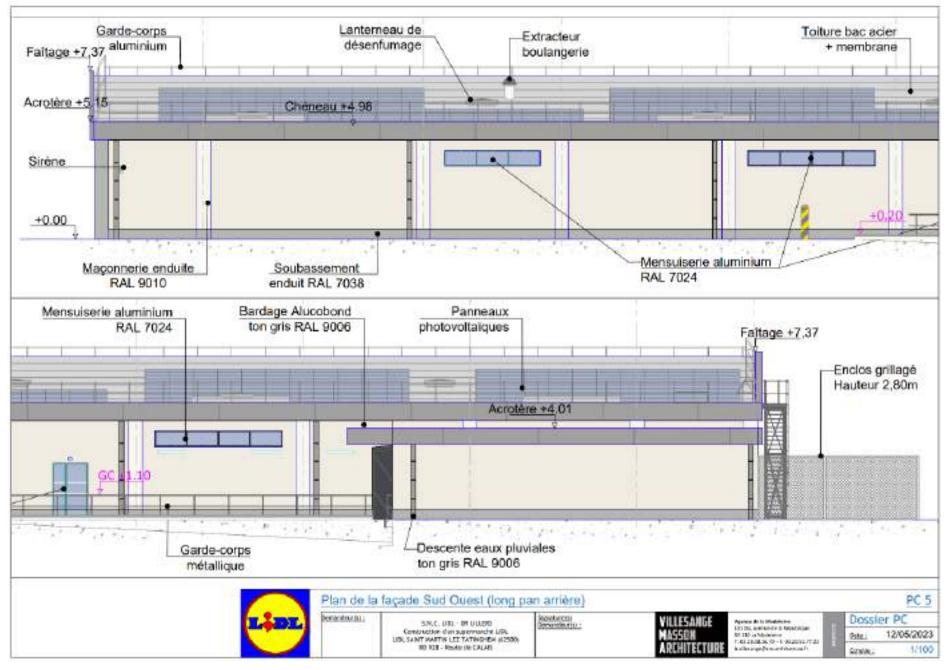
Plan de la façade sud-ouest; Source: Villesange Masson Architecture
